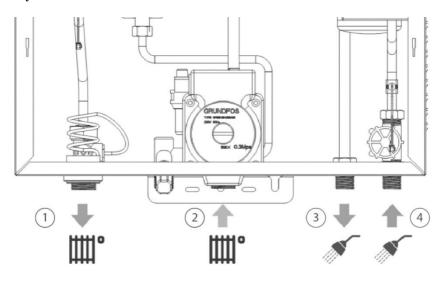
Raccordement aux systèmes de chauffage et d'alimentation en eau chaude
